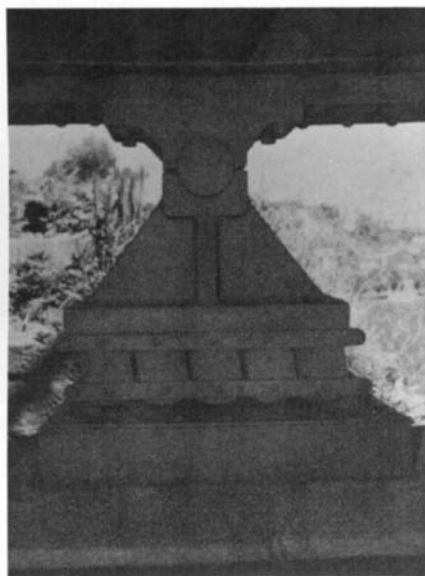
Apoio entre o tabuleiro superior e um pilar de alvenaria
